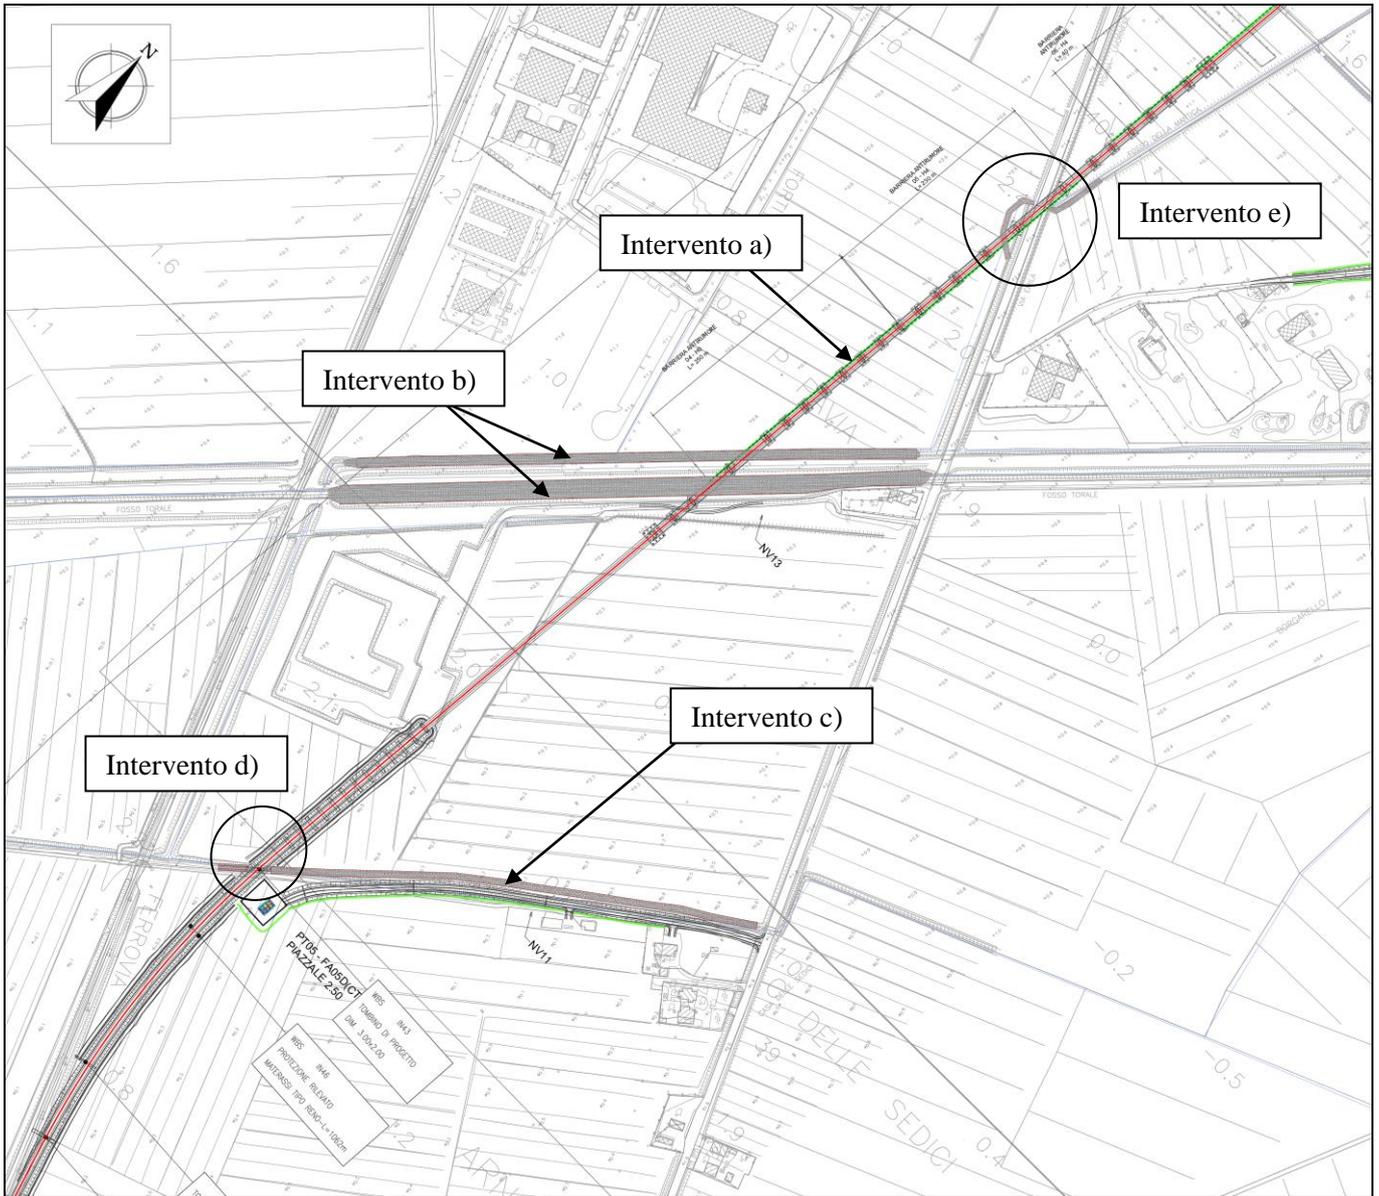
Stralcio della planimetria di progetto nell'area di studio.
